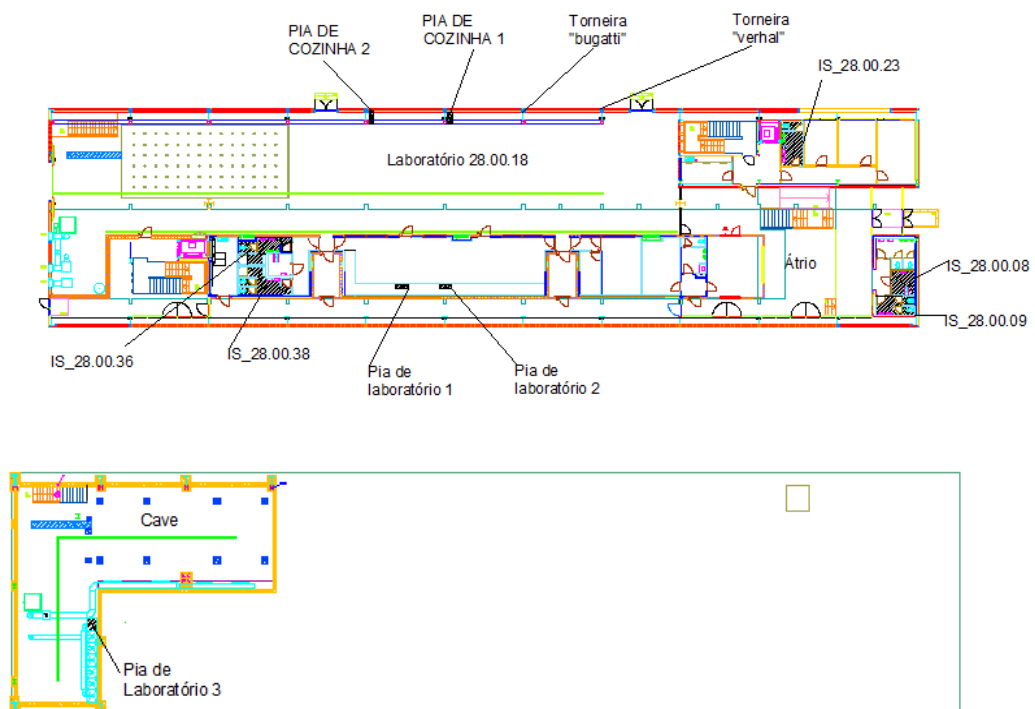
Planta esquemática do piso 0 e da cave (piso -1)
